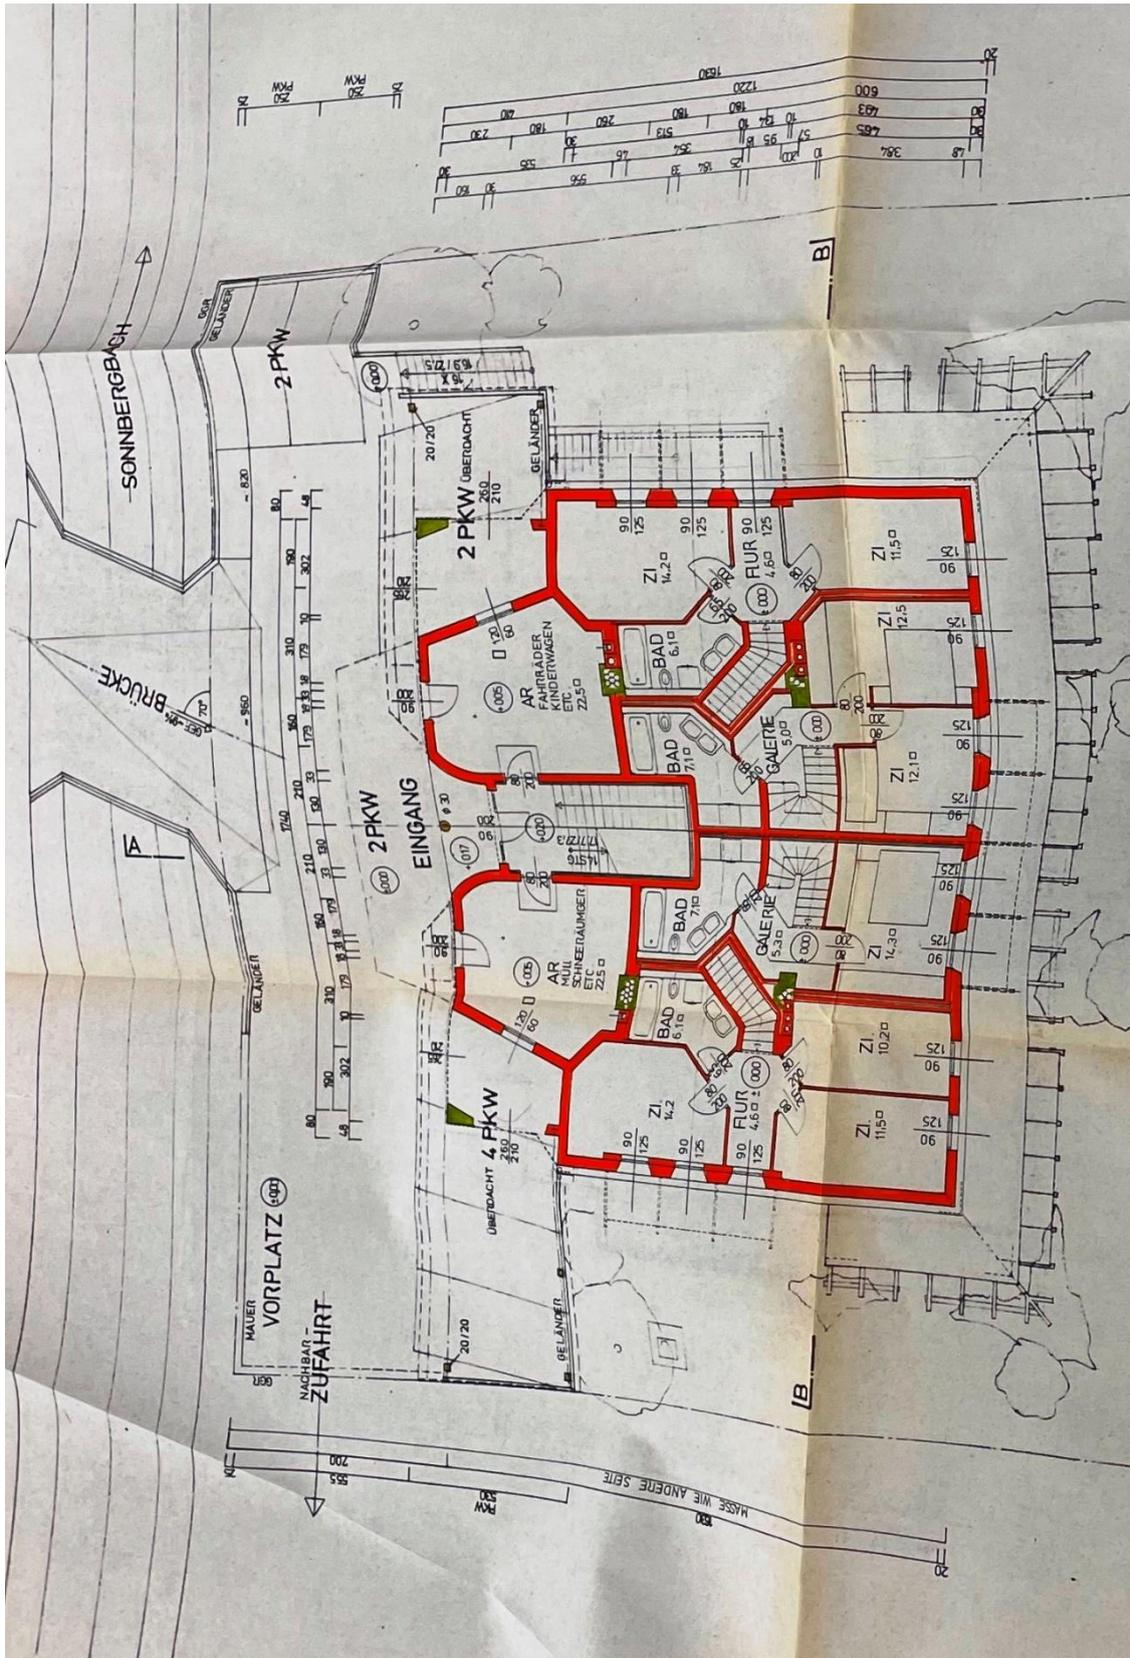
Grundriss 1. Obergeschoss (Carport / Stellplatz Top 14)
